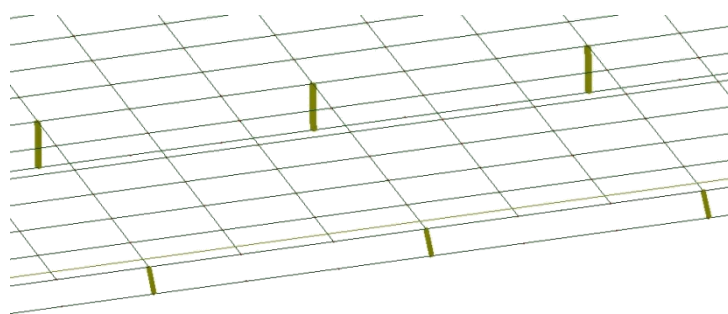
Ligações entre a laje e as longarinas exterior e central
